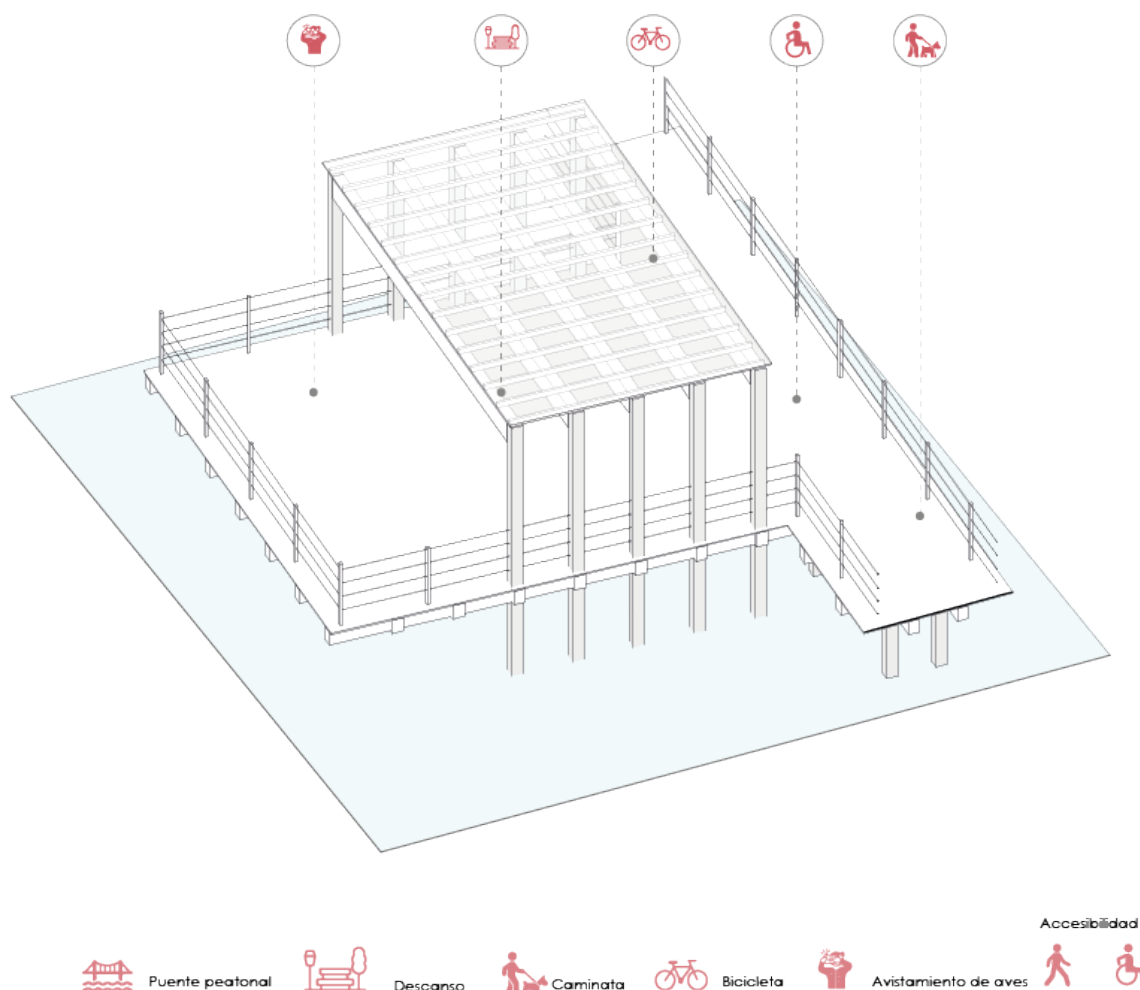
Axonometría – Caminera elevada. Fuente y Elaboración: Autora.
